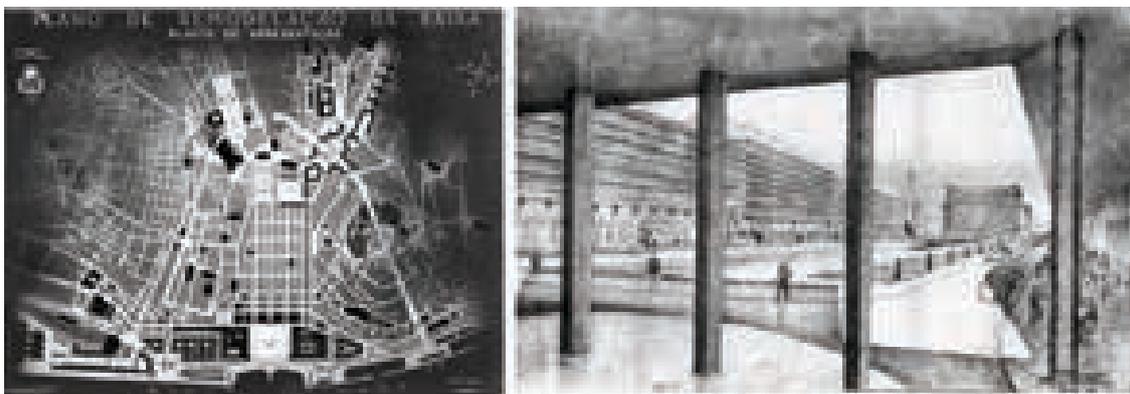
Plano de Remodelação da Baixa, Planta de Apresentação, Desenho da Praça da Figueira. (Fundação Calouste Gulbenkian. Biblioteca de Arte, 1949-1950).
